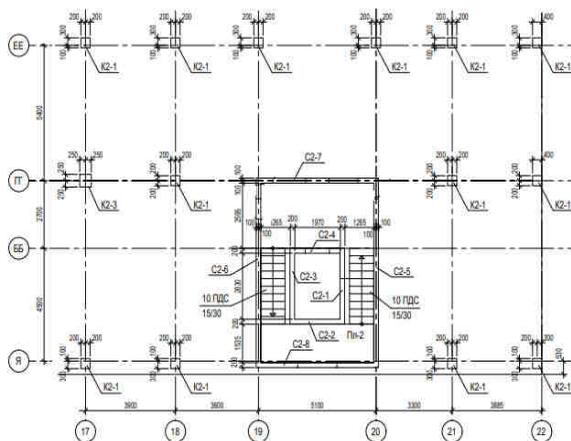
Схема расположения элементов монолитного железобетонного каркаса
